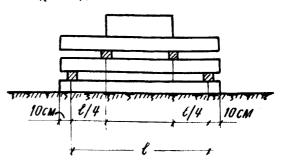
Схема расположения опор и нагру зок при заводских испытаниях плит
